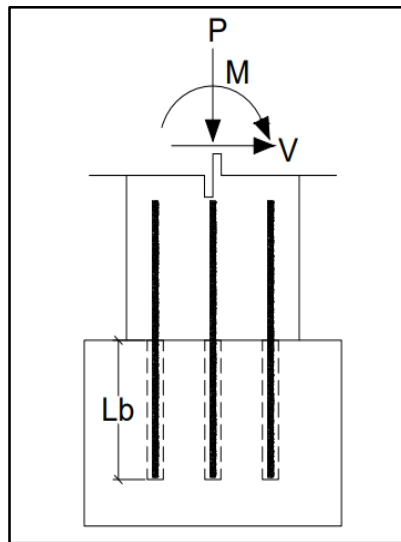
Longitud de empotramiento en la conexión con barras de proyección.
